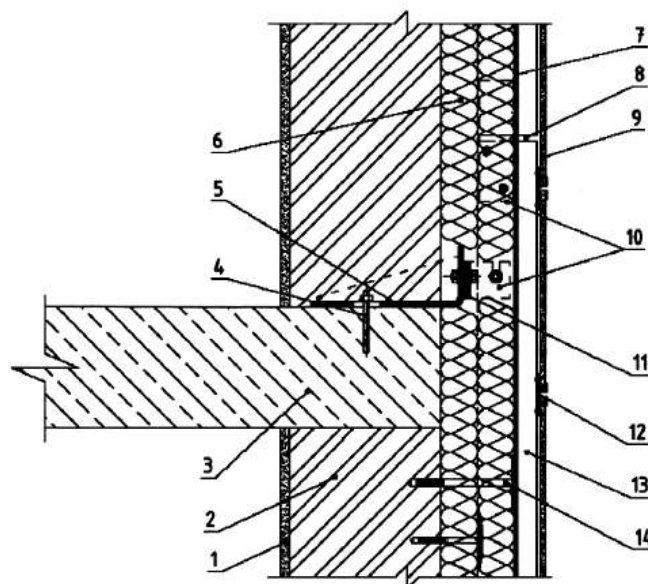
Конструктивна схема збірної системи з з вентиляованим повітряним прошарком та непрозорим індустриальним опорядженням з одношаровою тепловою ізоляцією [19]:
